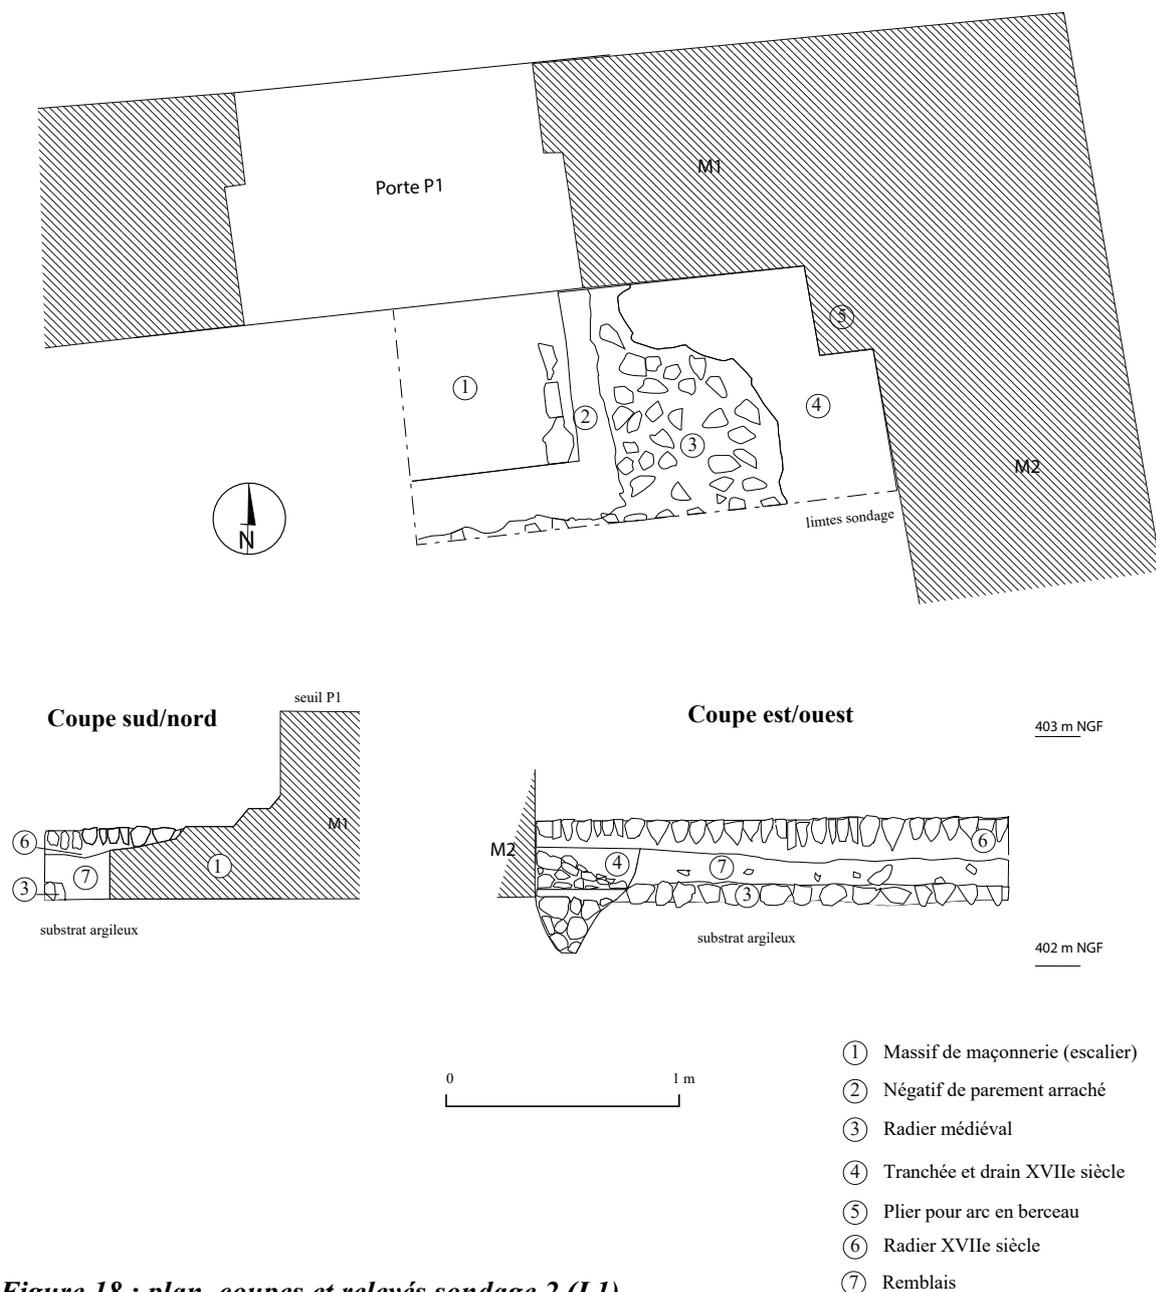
plan, coupes et relevés sondage 2 (L1).
